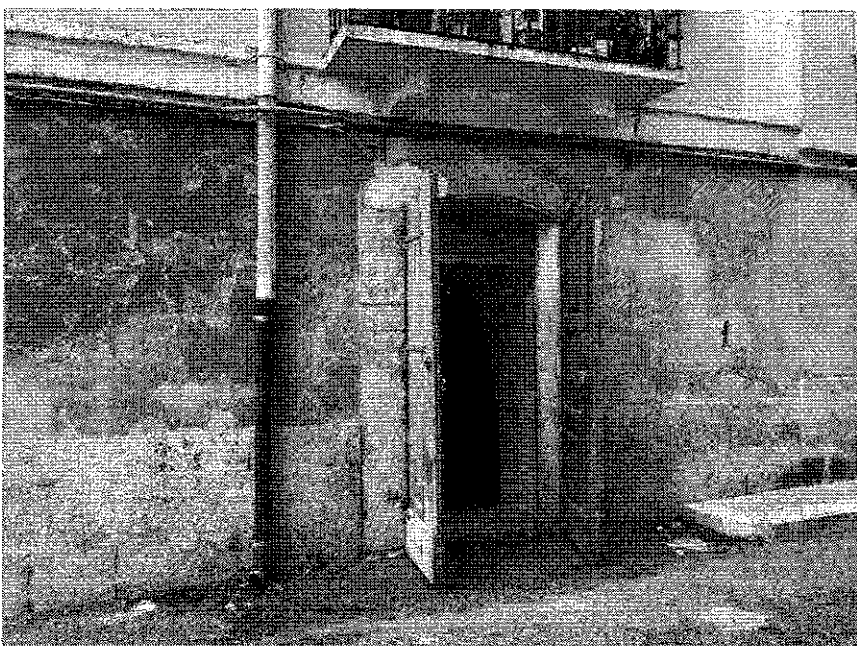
Ingresso locale piano terra – Via Staffa n. 1
